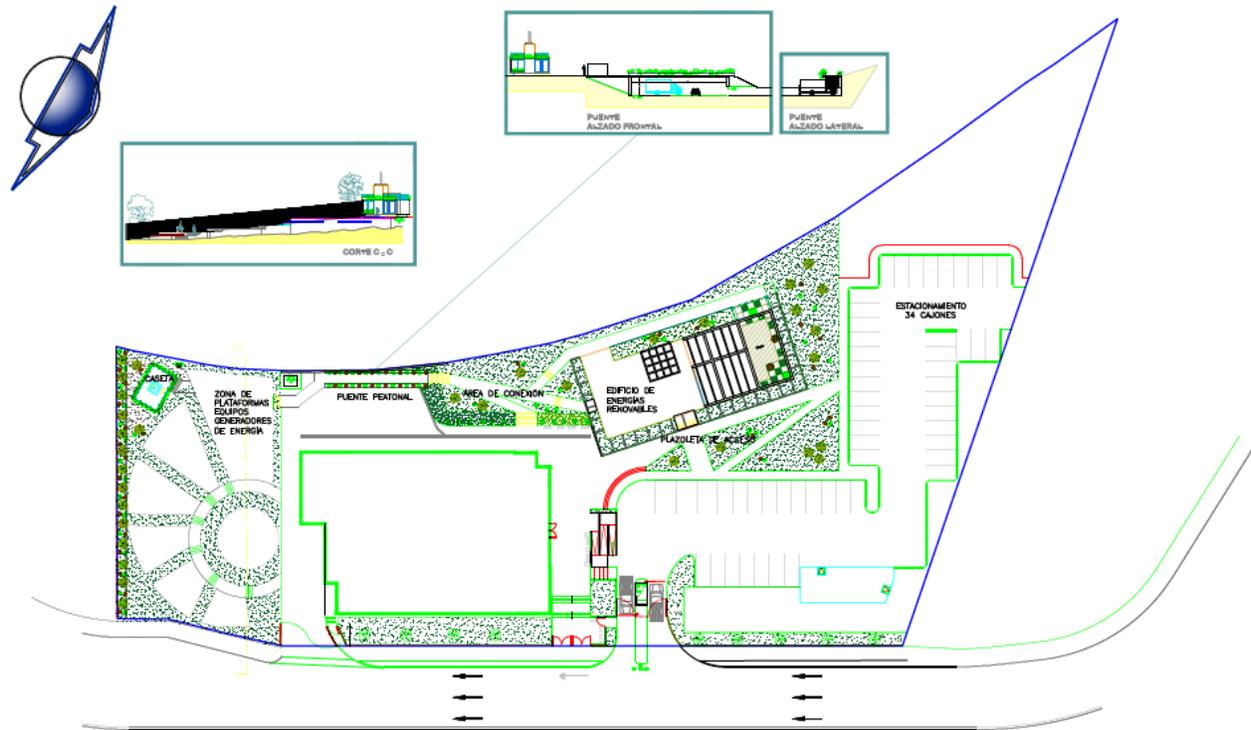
Planta de conjunto del proyecto CIATEQ, en el Municipio de Zapopan, Jal.
